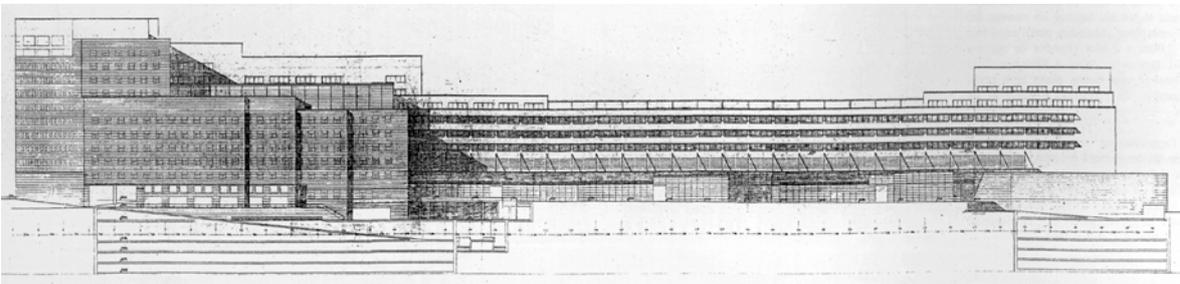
Fachada por la Avenida Diagonal, proyecto ejecutivo L'Illa Diagonal.
